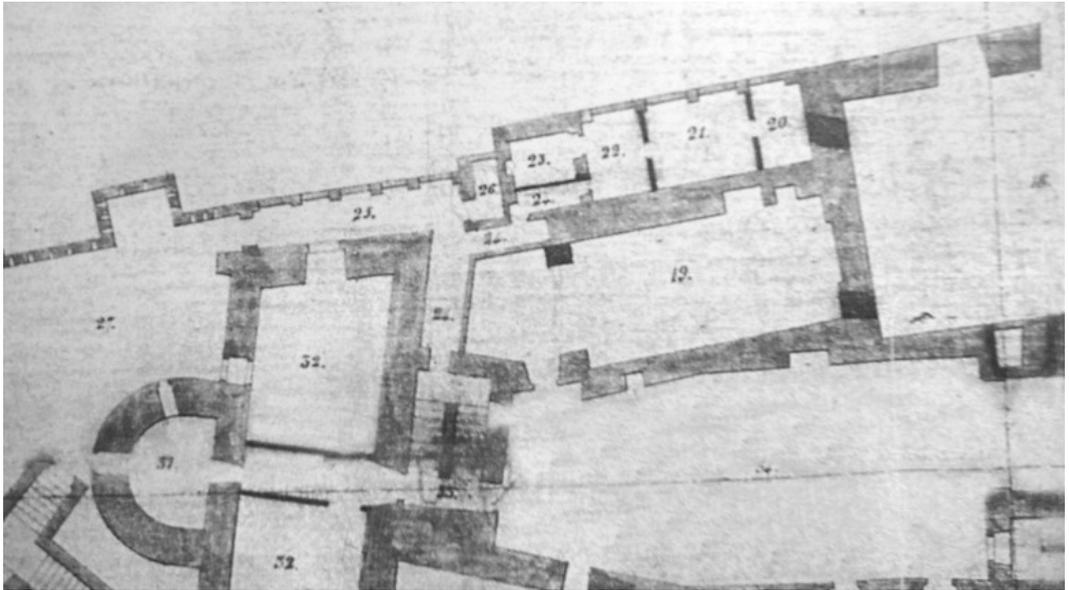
Plano de los Ingenieros Sierra y Cayuela, planta primera, detalle capilla (Cantalejo San Frutos, 1996: planimetría, proyecto 1).
